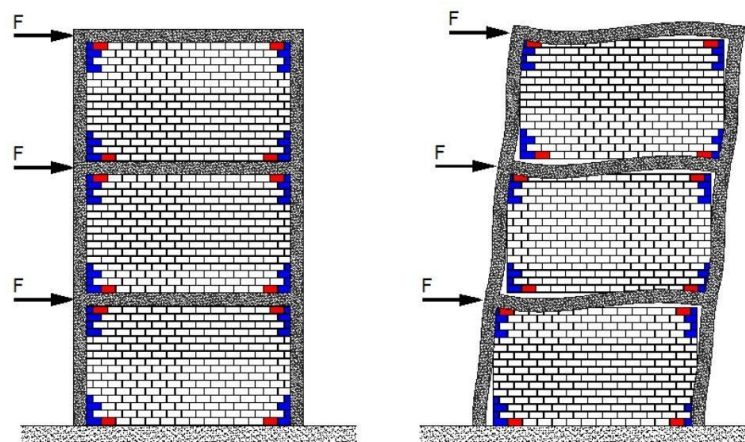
[Deformación del pórtico ante fuerzas horizontales utilizando ladrillo aislador sísmico SISBRICK. Protección de pilares y tabiques.]
